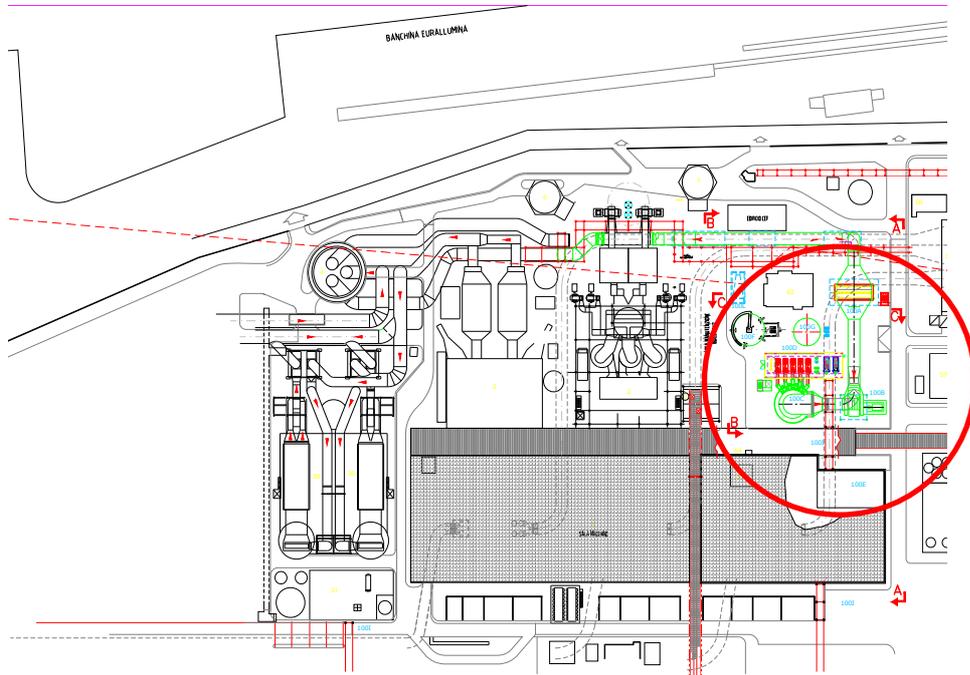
pianta schematica con indicazione dell'ubicazione del DeSOx
